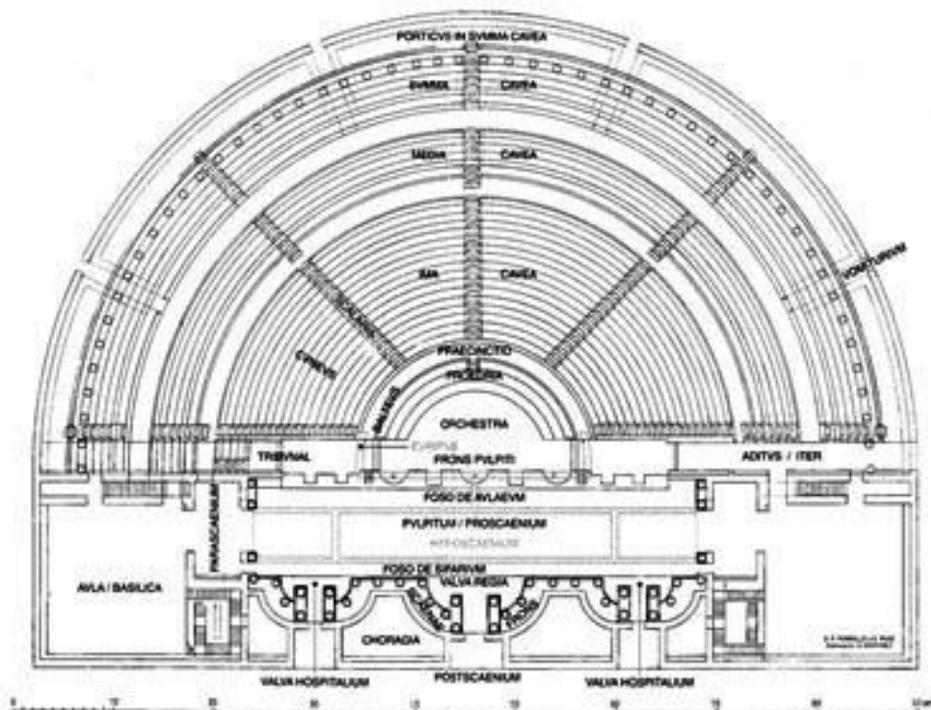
Planta Arquitectónica, Teatro Pompeya. Fuente: Wikipedia, 2011.
